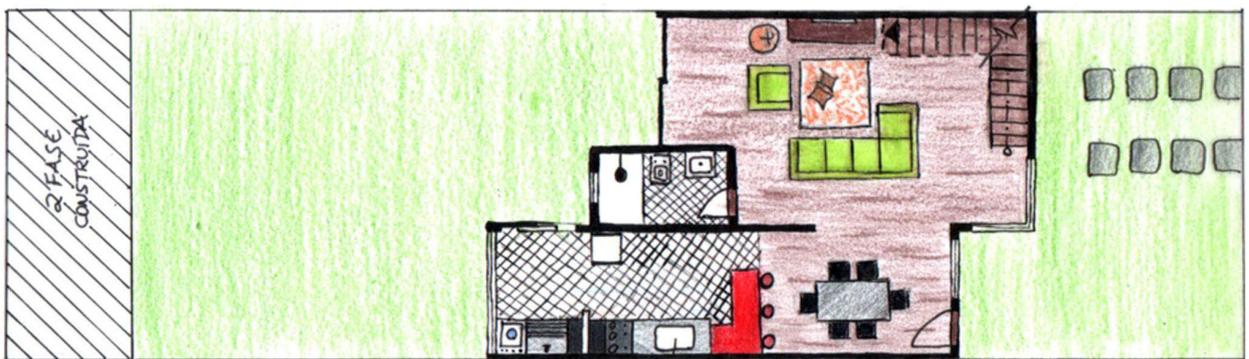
Planta-baixa pavimento superior. Estudo preliminar.
